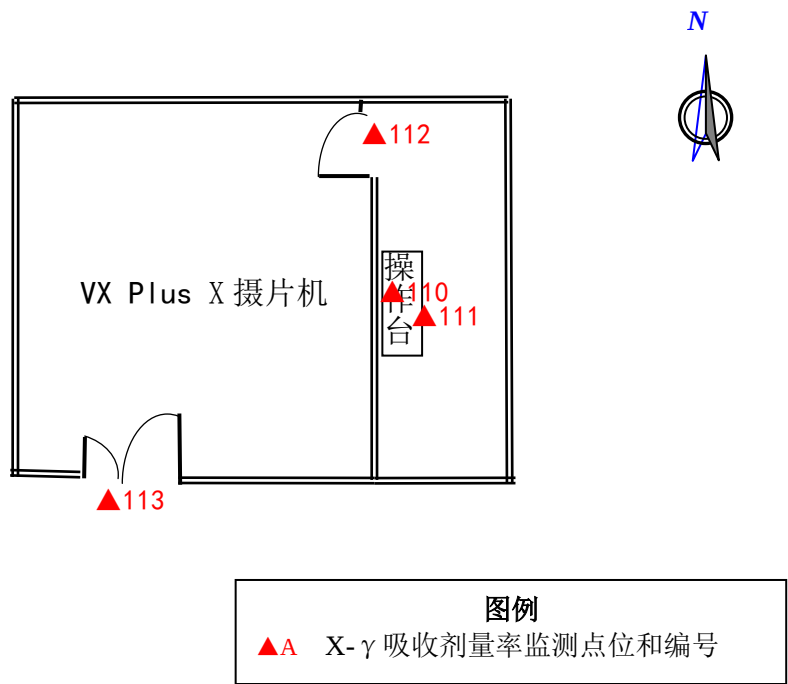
VX Plus X 摄片机房平面布置简图及监测点位图
